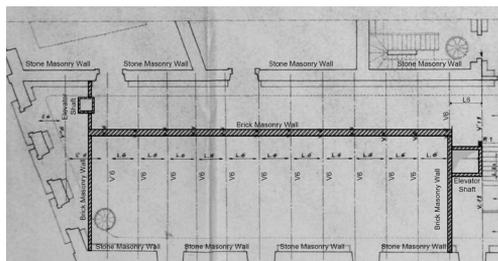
Planta do setor do piso 2 em análise (adaptação aos desenhos originais) [10].
